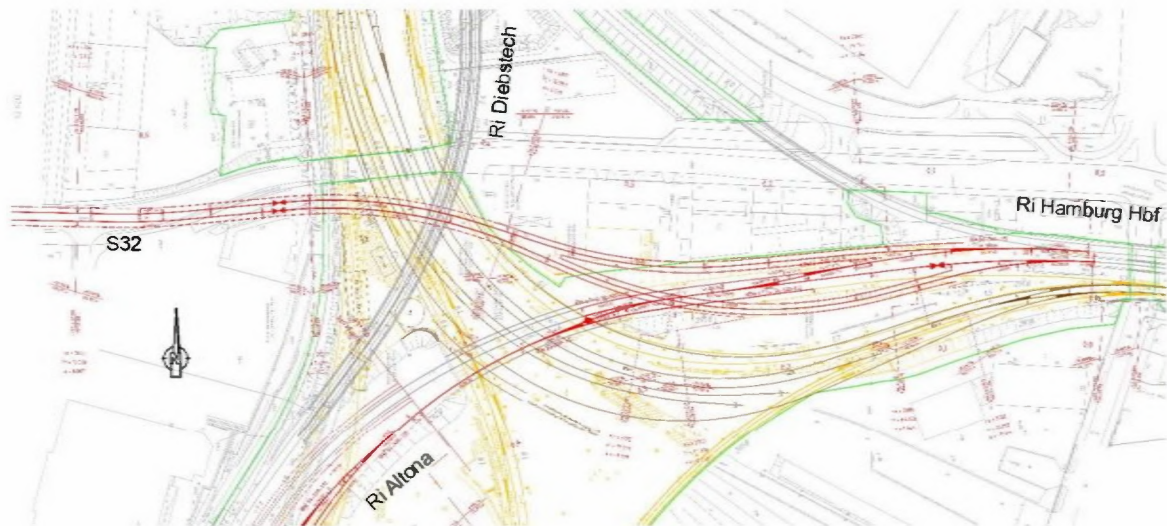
Machbarkeitsstudie S32 – Lageplan Anschluss an Strecke 1240 [U17]
